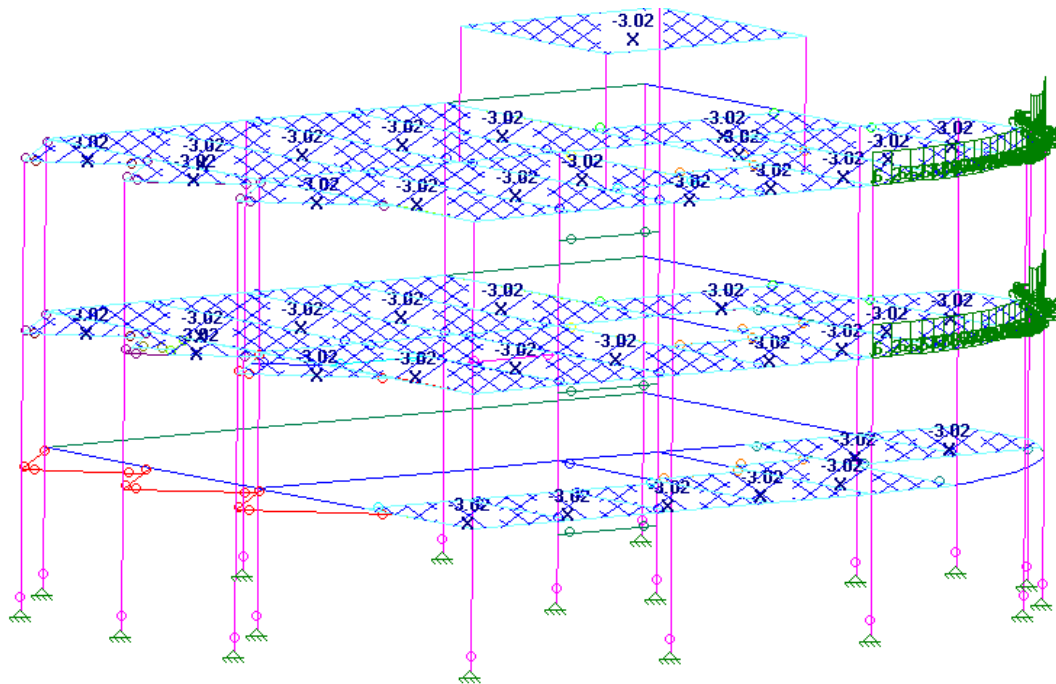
Laje *steel deck* e laje em balanço – Carregamento aplicado
